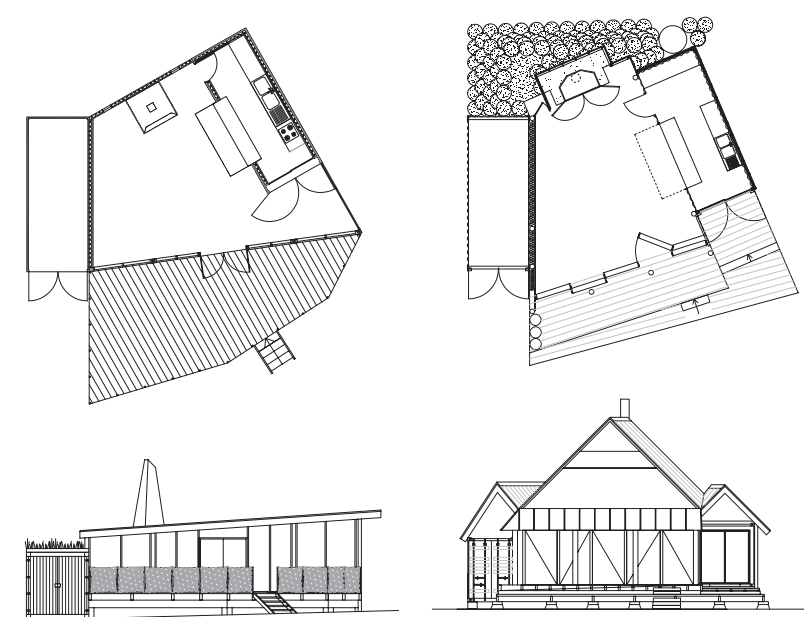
Le Manable, Plans/Élévation : Dépôt de permis de construire (gauche) et PC modificatif (Droite).
